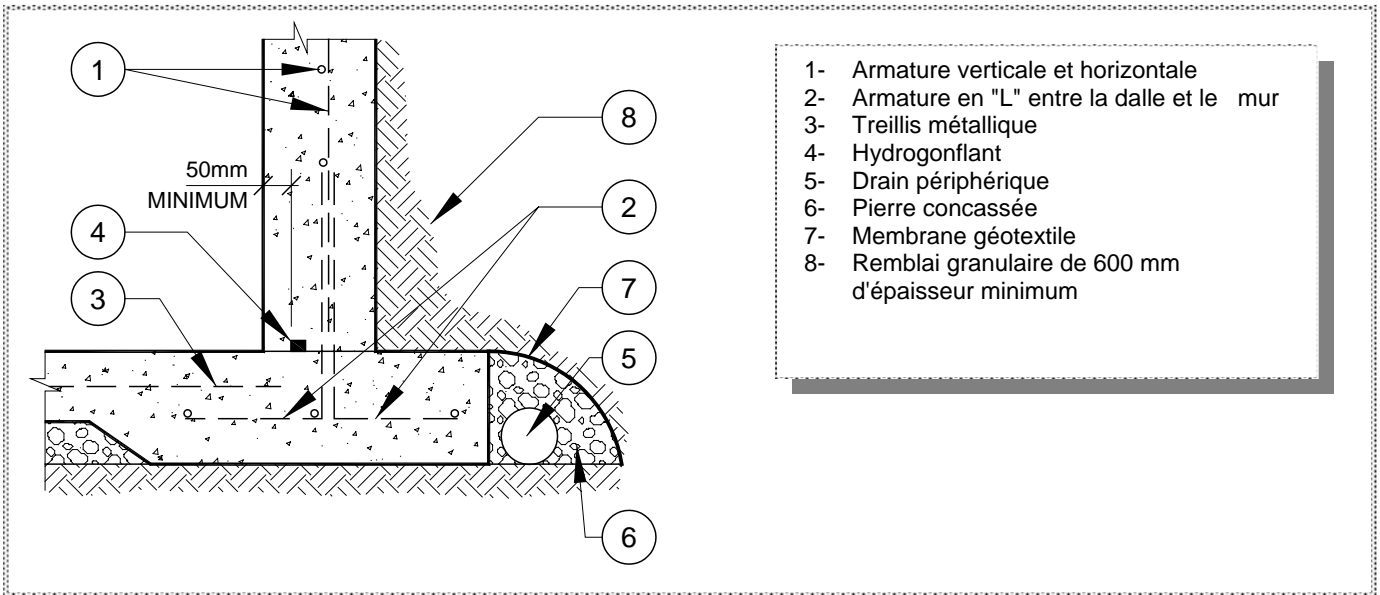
Étanchéité entre la dalle et le mur (Joint de construction)
